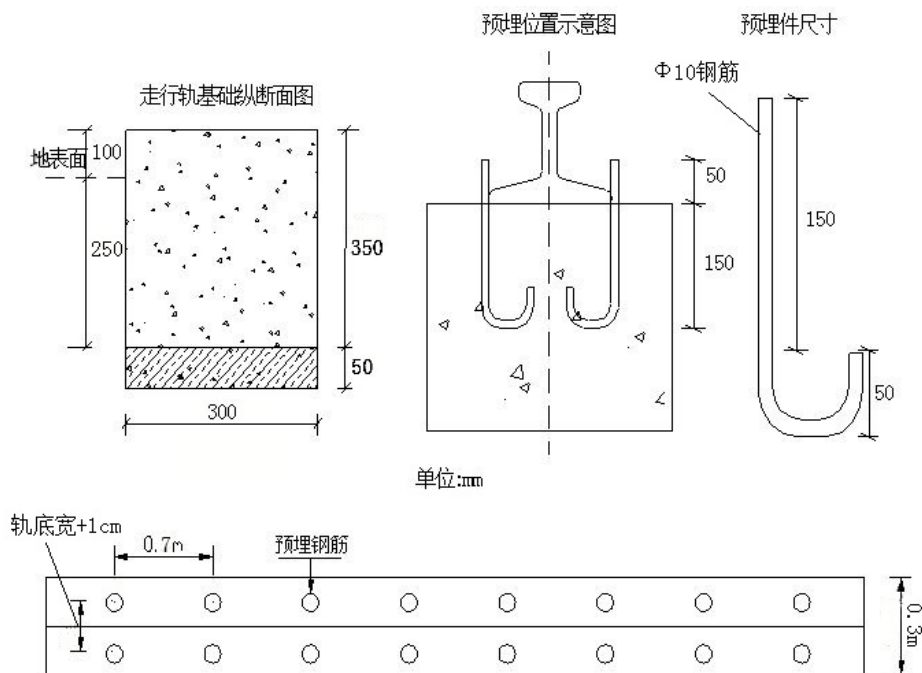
龙门吊走行线预埋钢筋平面位置示意图
